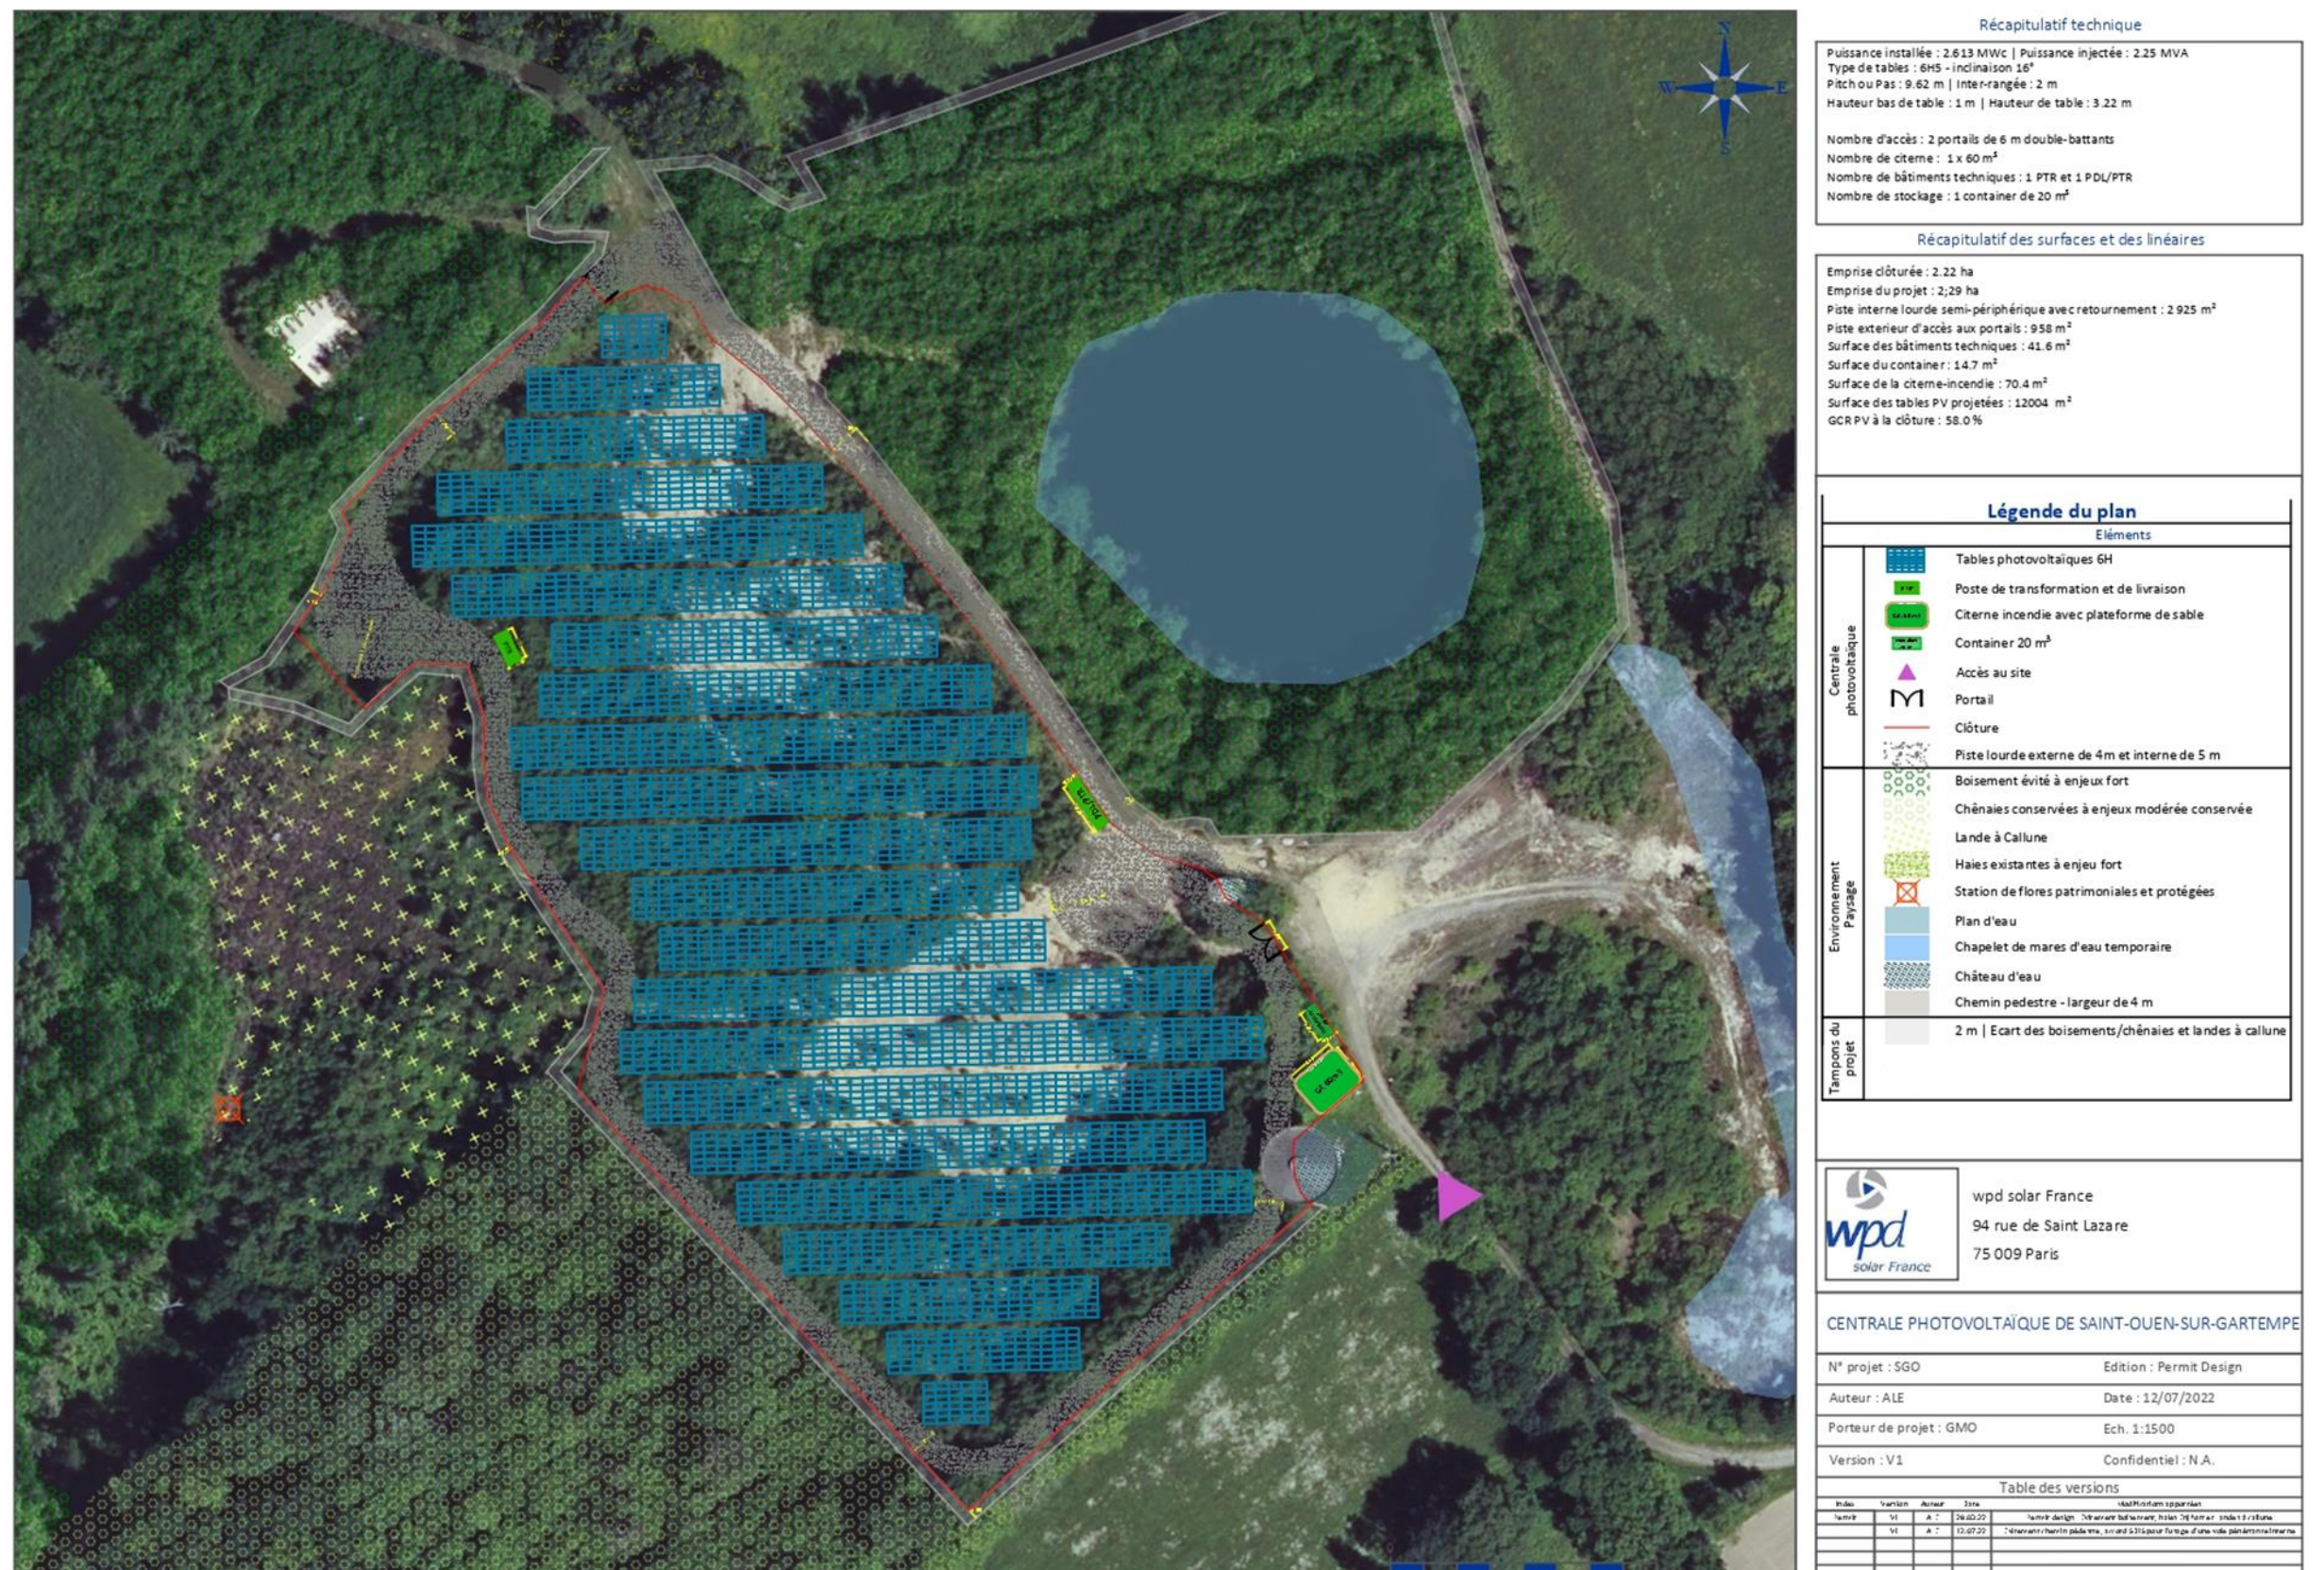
Plan de masse de la centrale photovoltaïque de Saint-Ouen sur Gartempe
